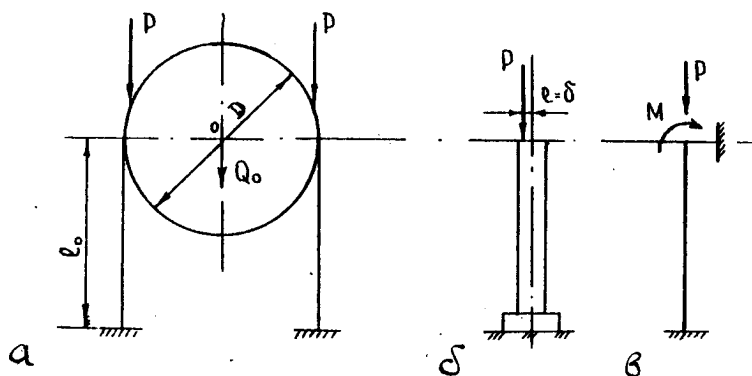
Схема навантаження і розрахунку опорних стоек
